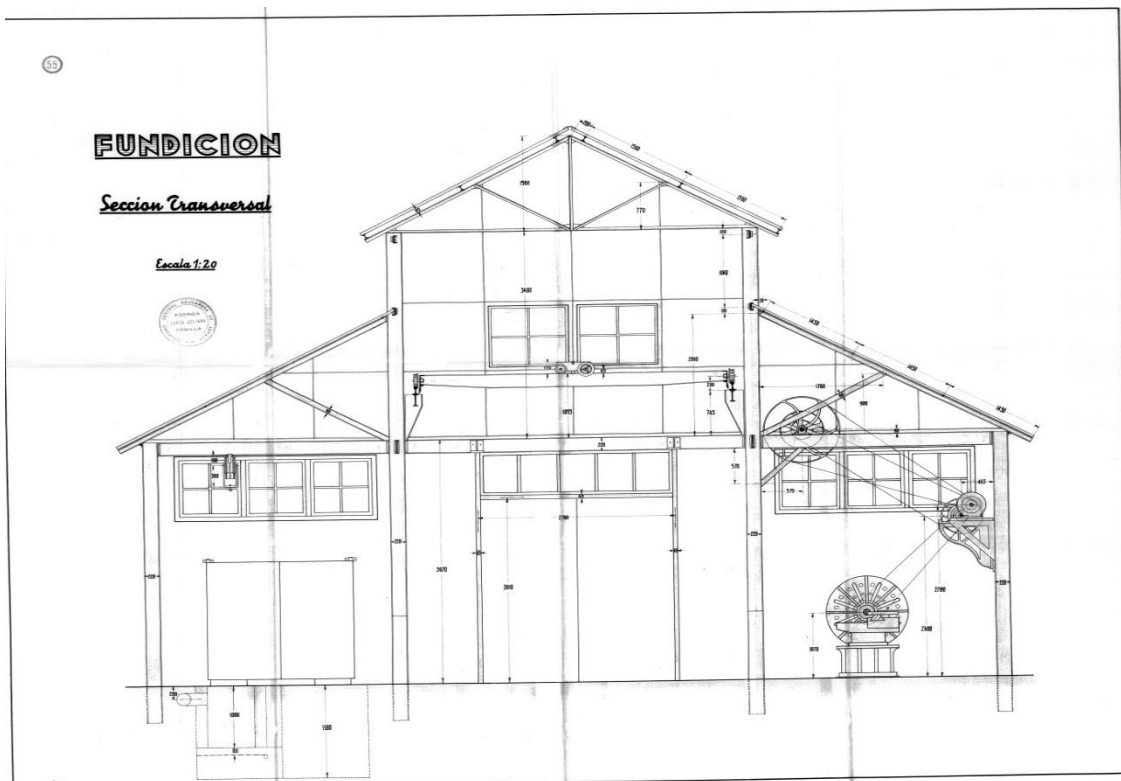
Plano de la sección transversal de la Fundición de la azucarera Santa Juliana (Armillas). Fuente: ASGAE. Benavente
